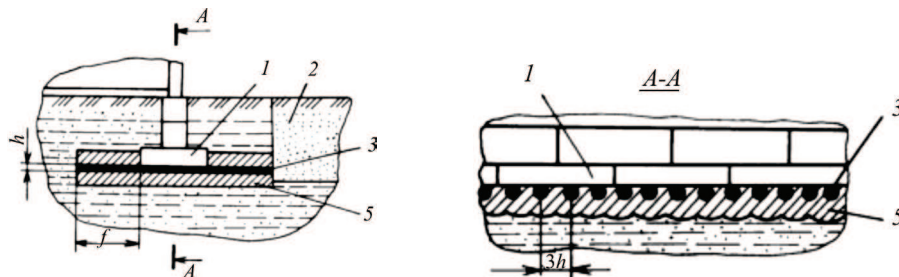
Способ усиления основания ленточных фундаментов с помощью создания под подошвой ГИК: 1 – фундамент; 2 – технологический приямок; 3 – геоимплантат; 5 – зона уплотненного грунта
